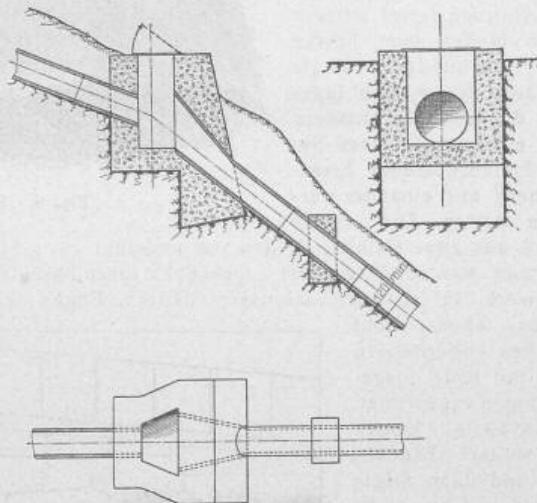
11. Grundriss und Schnitte der Ueberfall-Leitung mit Betonmassiv. 1:150.
